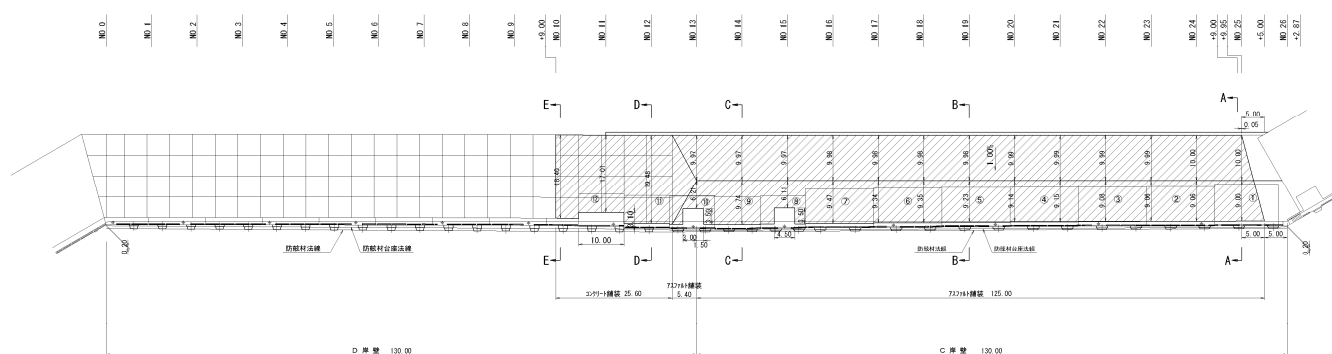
No.3 南公共ふ頭C岸壁(-7.5m)舗装工平面図(復旧後)
